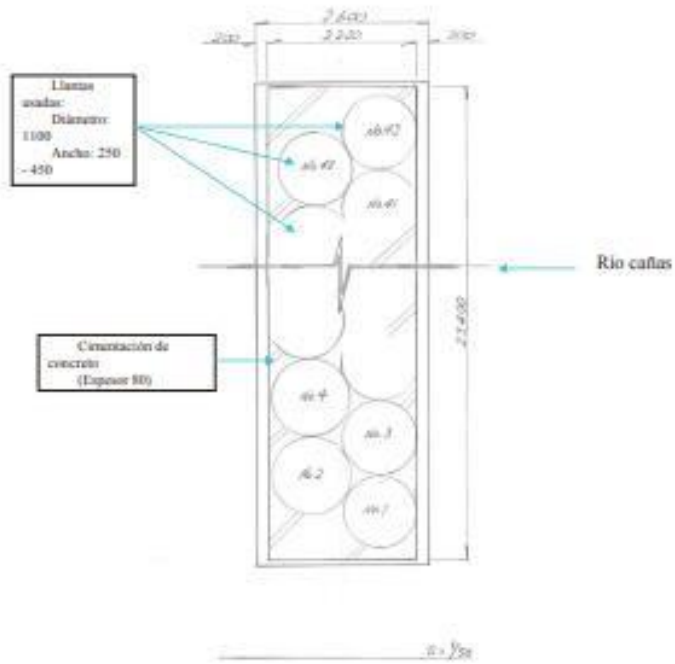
Planos de un dique levantado con las llantas usadas (planta)
